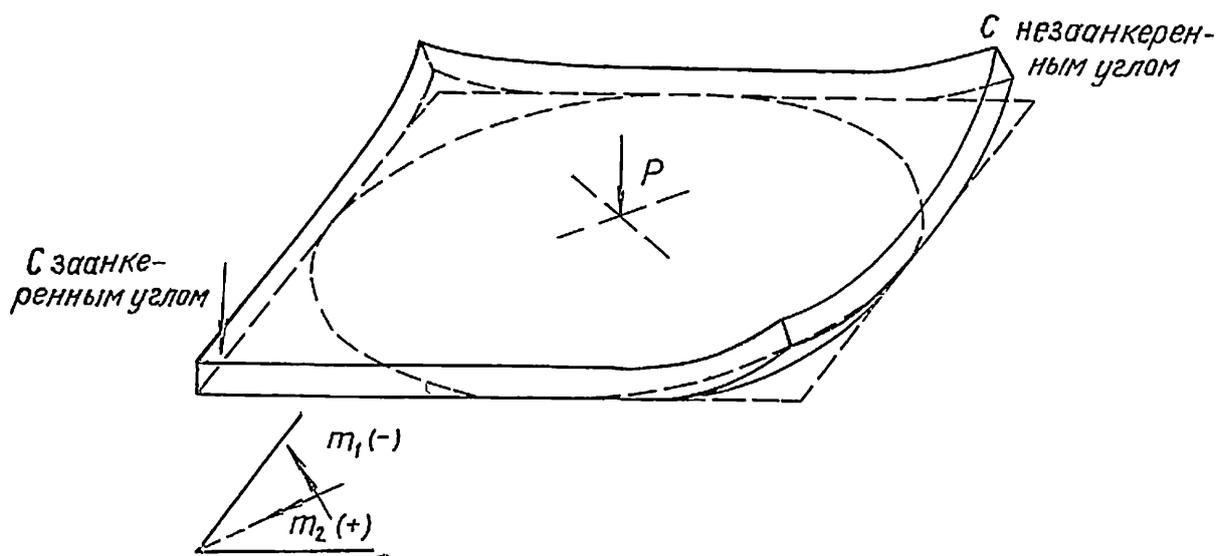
I - 2I. Свободно лежащая плита приподнимается по углам под нагрузкой, если она там не заанкерена
